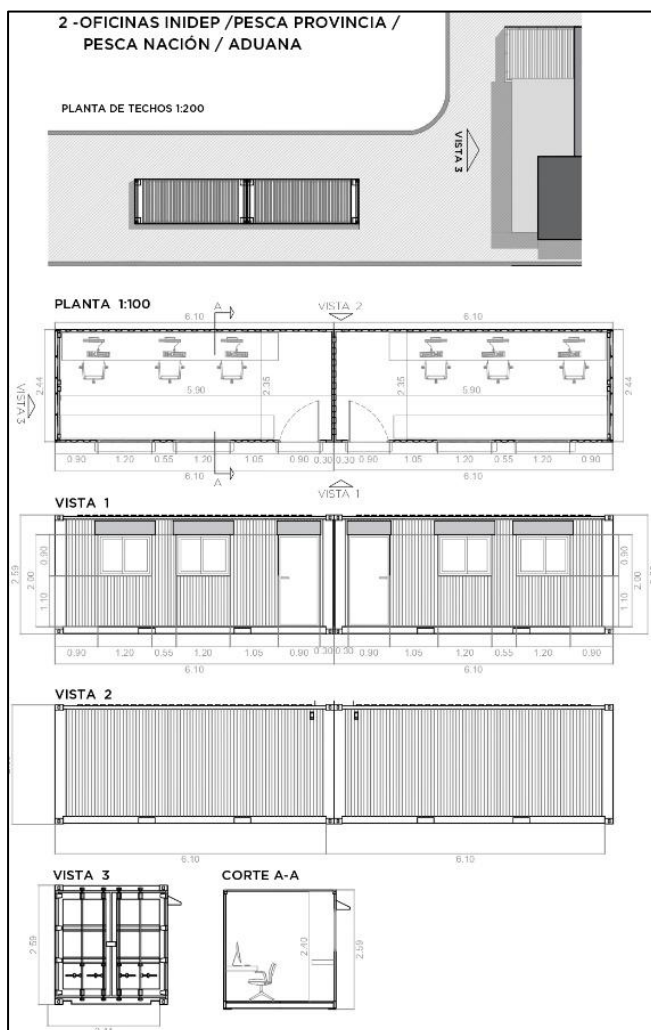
Plano - oficinas administrativas modulares. Planta 1:100
